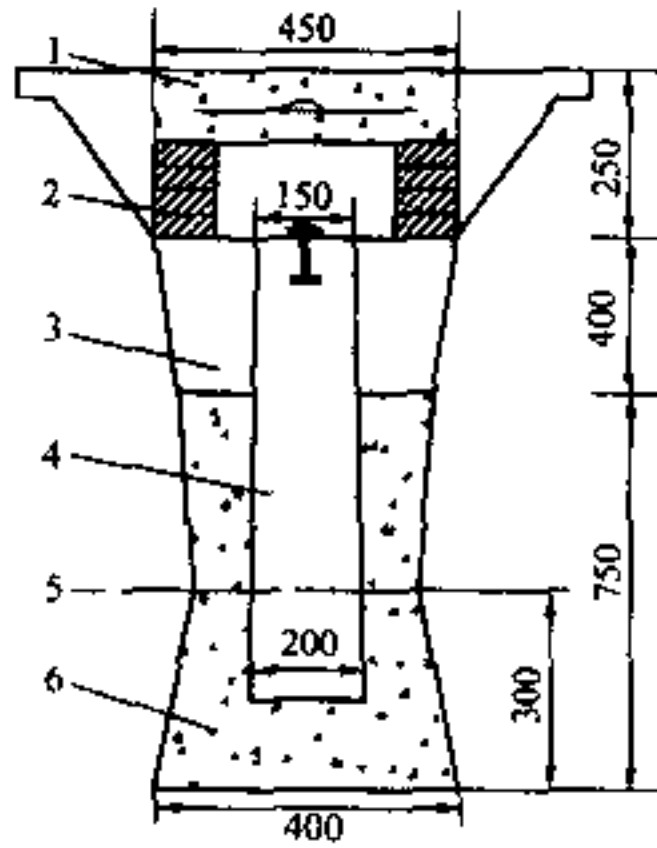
1 混凝土水准点标石埋设 (单位: mm)
